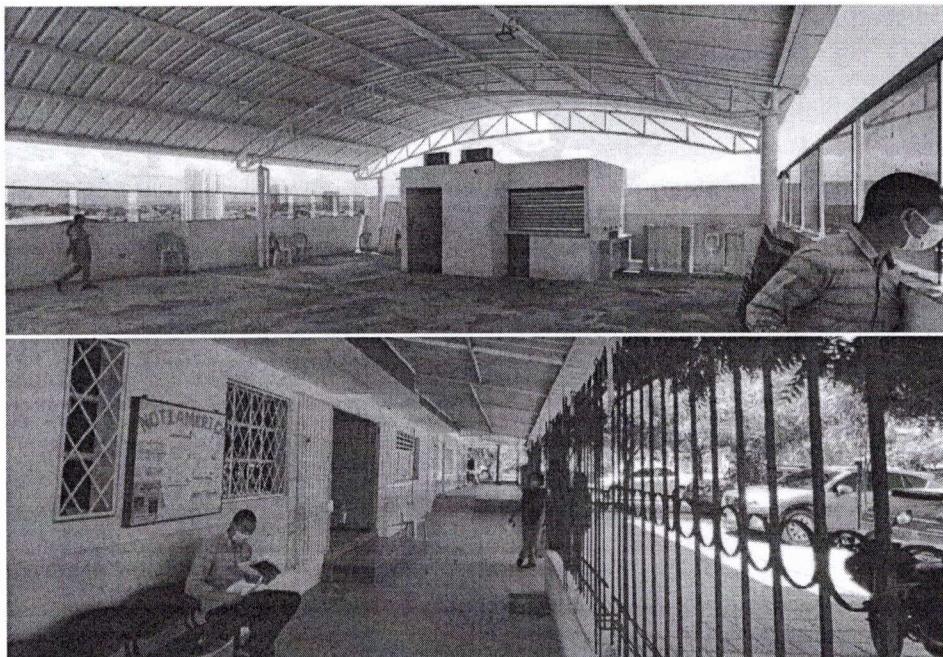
Altillo con cubierta en lámina delgada soportada en estructura metálica y zona de antejardín de los predios en mención (Barrio Nuevo Bosque). Nótese antejardín techado en cubierta metálica y cerramiento perimetral en muro y reja alta. Fuente: Dirección de Control Urbano - DCU, 2022.
